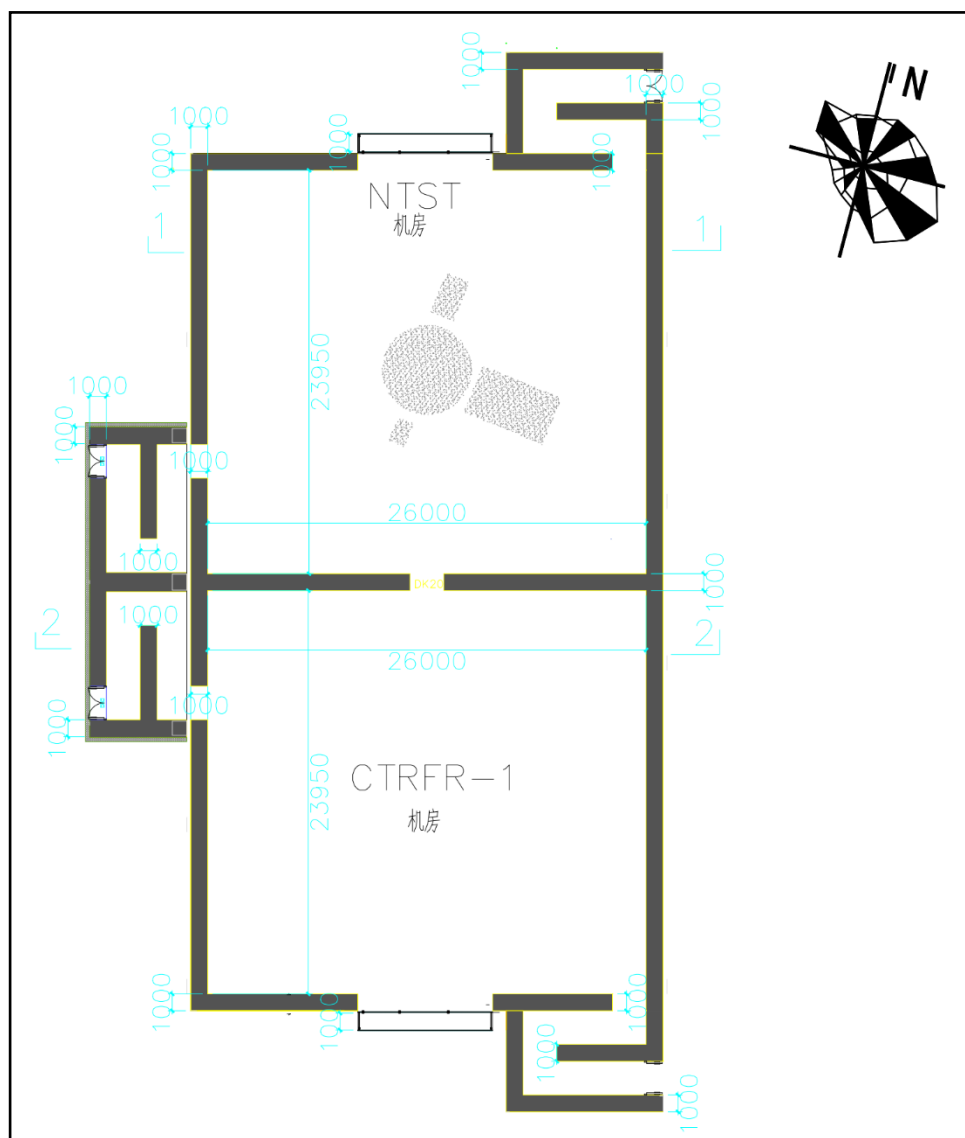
“CTRFR-1”装置机房及“NTST”装置机房屏蔽设计图（平面图）
